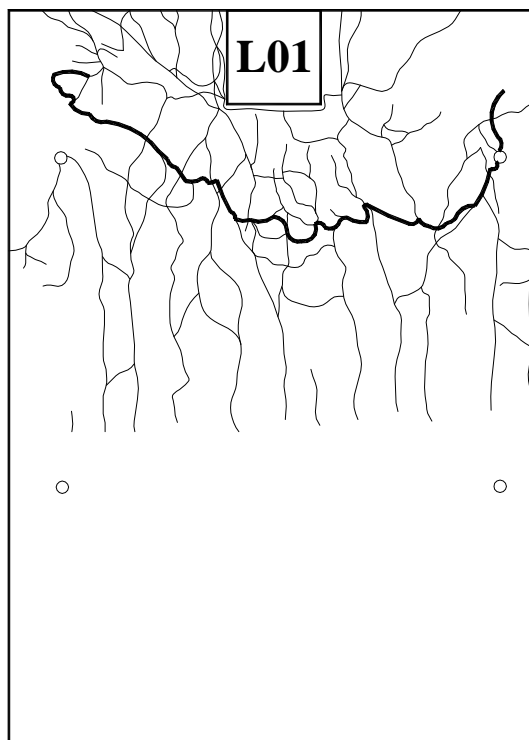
Padrão de fissuração da face superior da laje – L1
